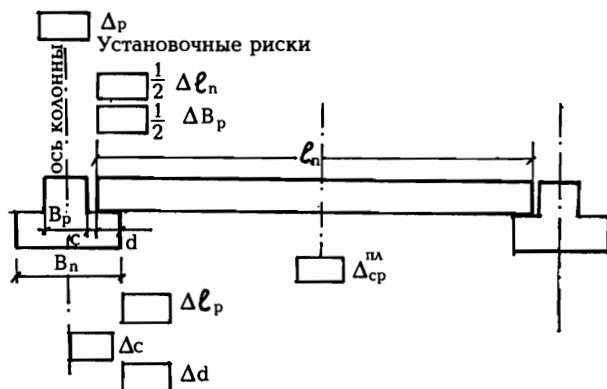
Схема допусков при монтаже связевых плит
